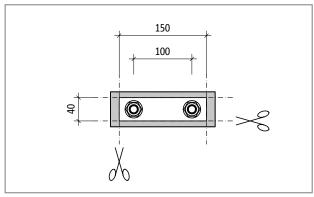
Schöck Isokorb® T Typ S-N: Maße nach Abschneiden des Dämmkörpers
